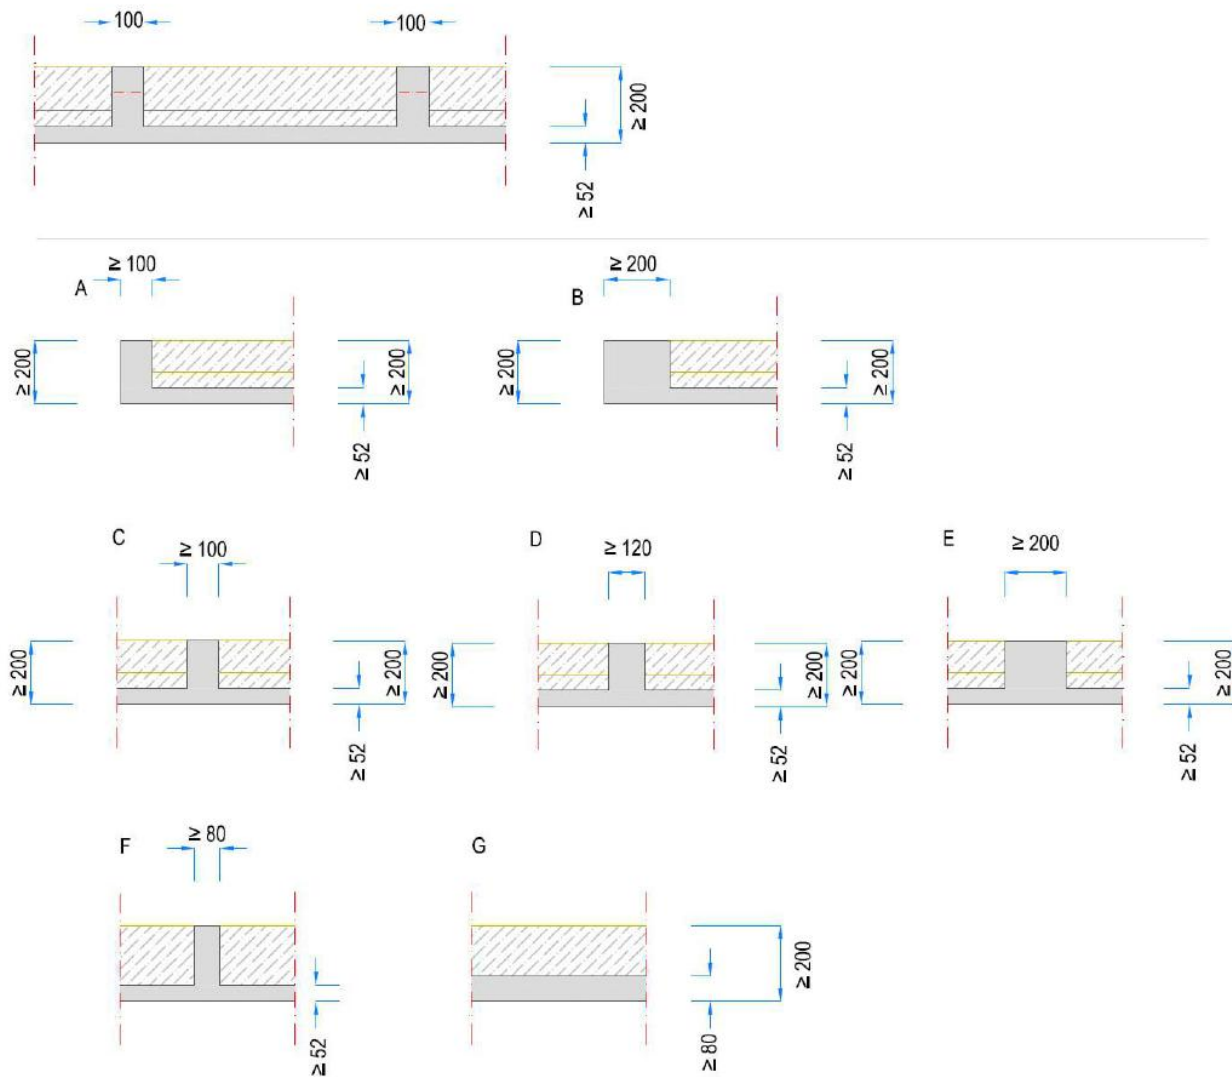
Sección estructural con aislamiento entre nervios rectangulares con la cara nervada hacia el exterior en techos.
